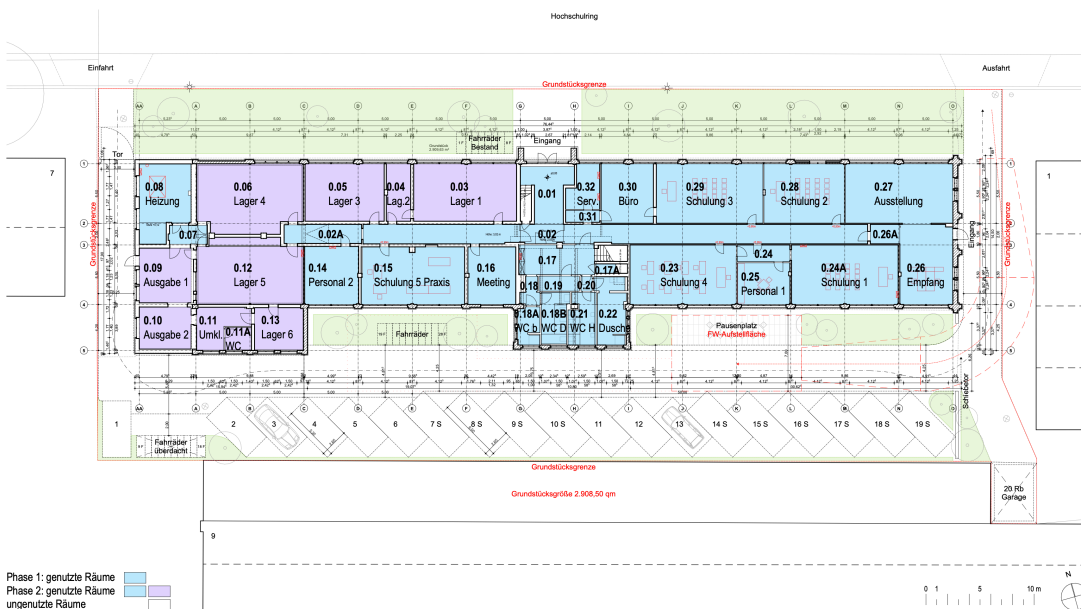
Phase II – Erweiterung der Nutzung – Grundriss EG
